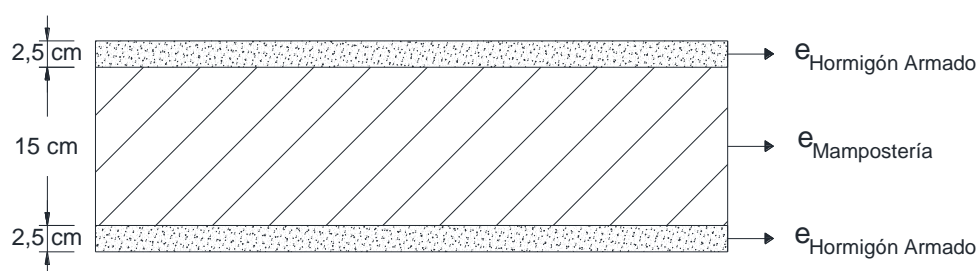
Sección Mampostería Reforzada – Modelación ETABS 2016.
